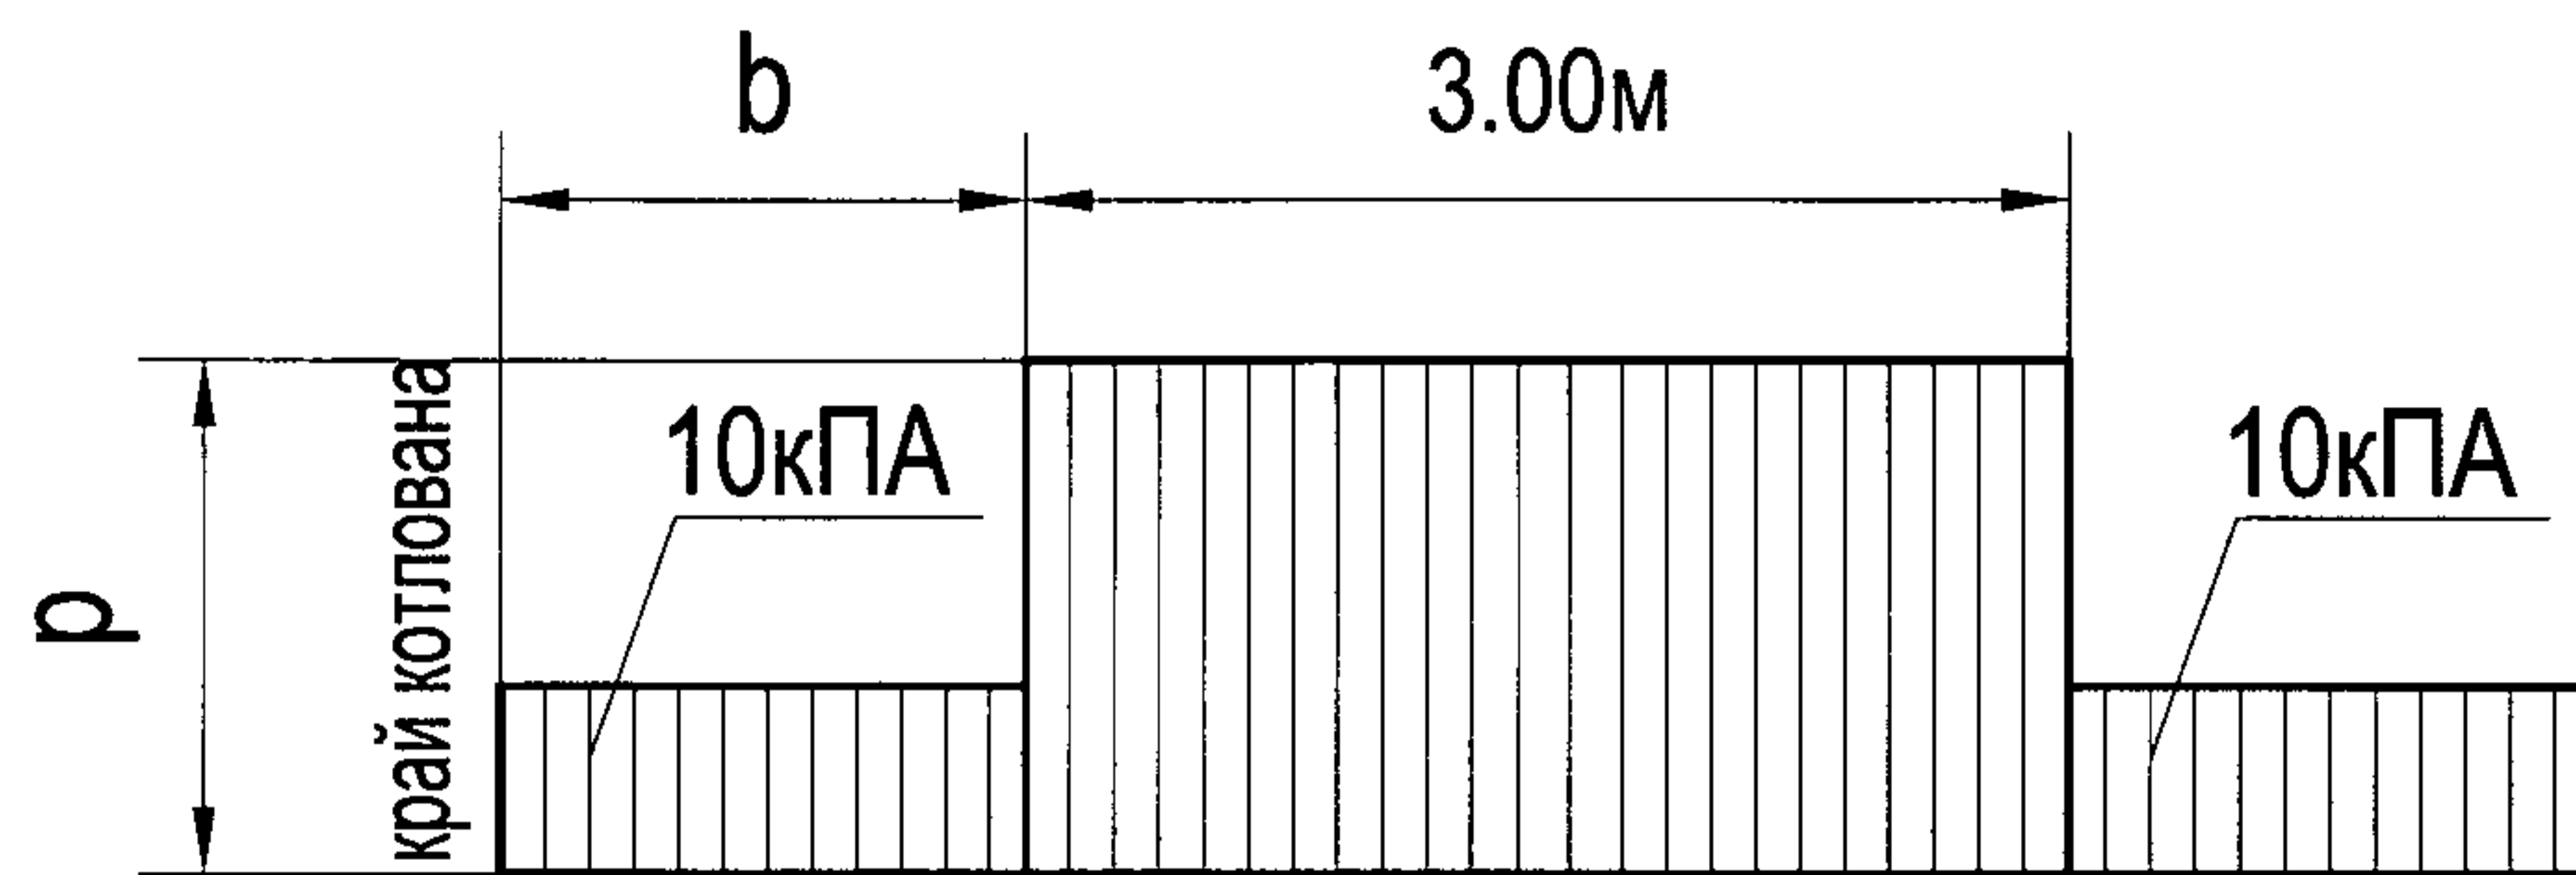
Вертикальная нагрузка на призме обрушения от автотранспорта
